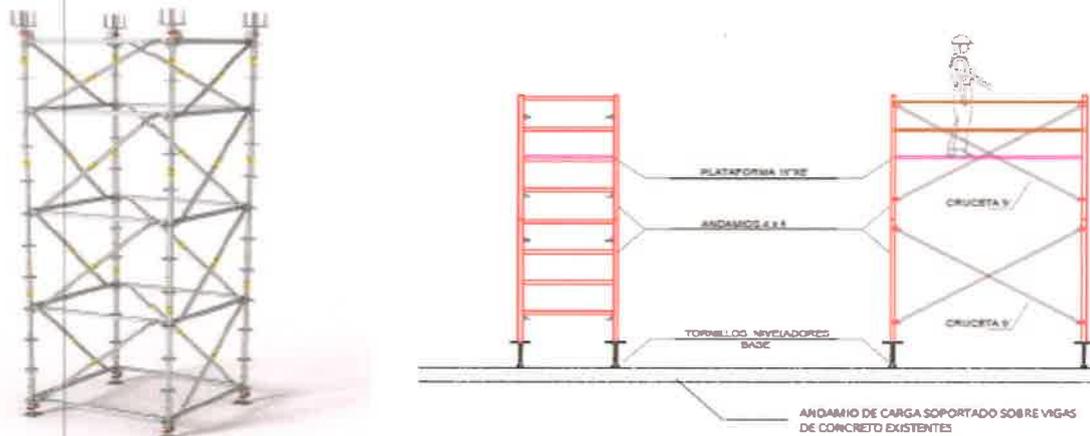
y 19: Sistema de Andamiaje Soportado Sobre Vigas Existentes
